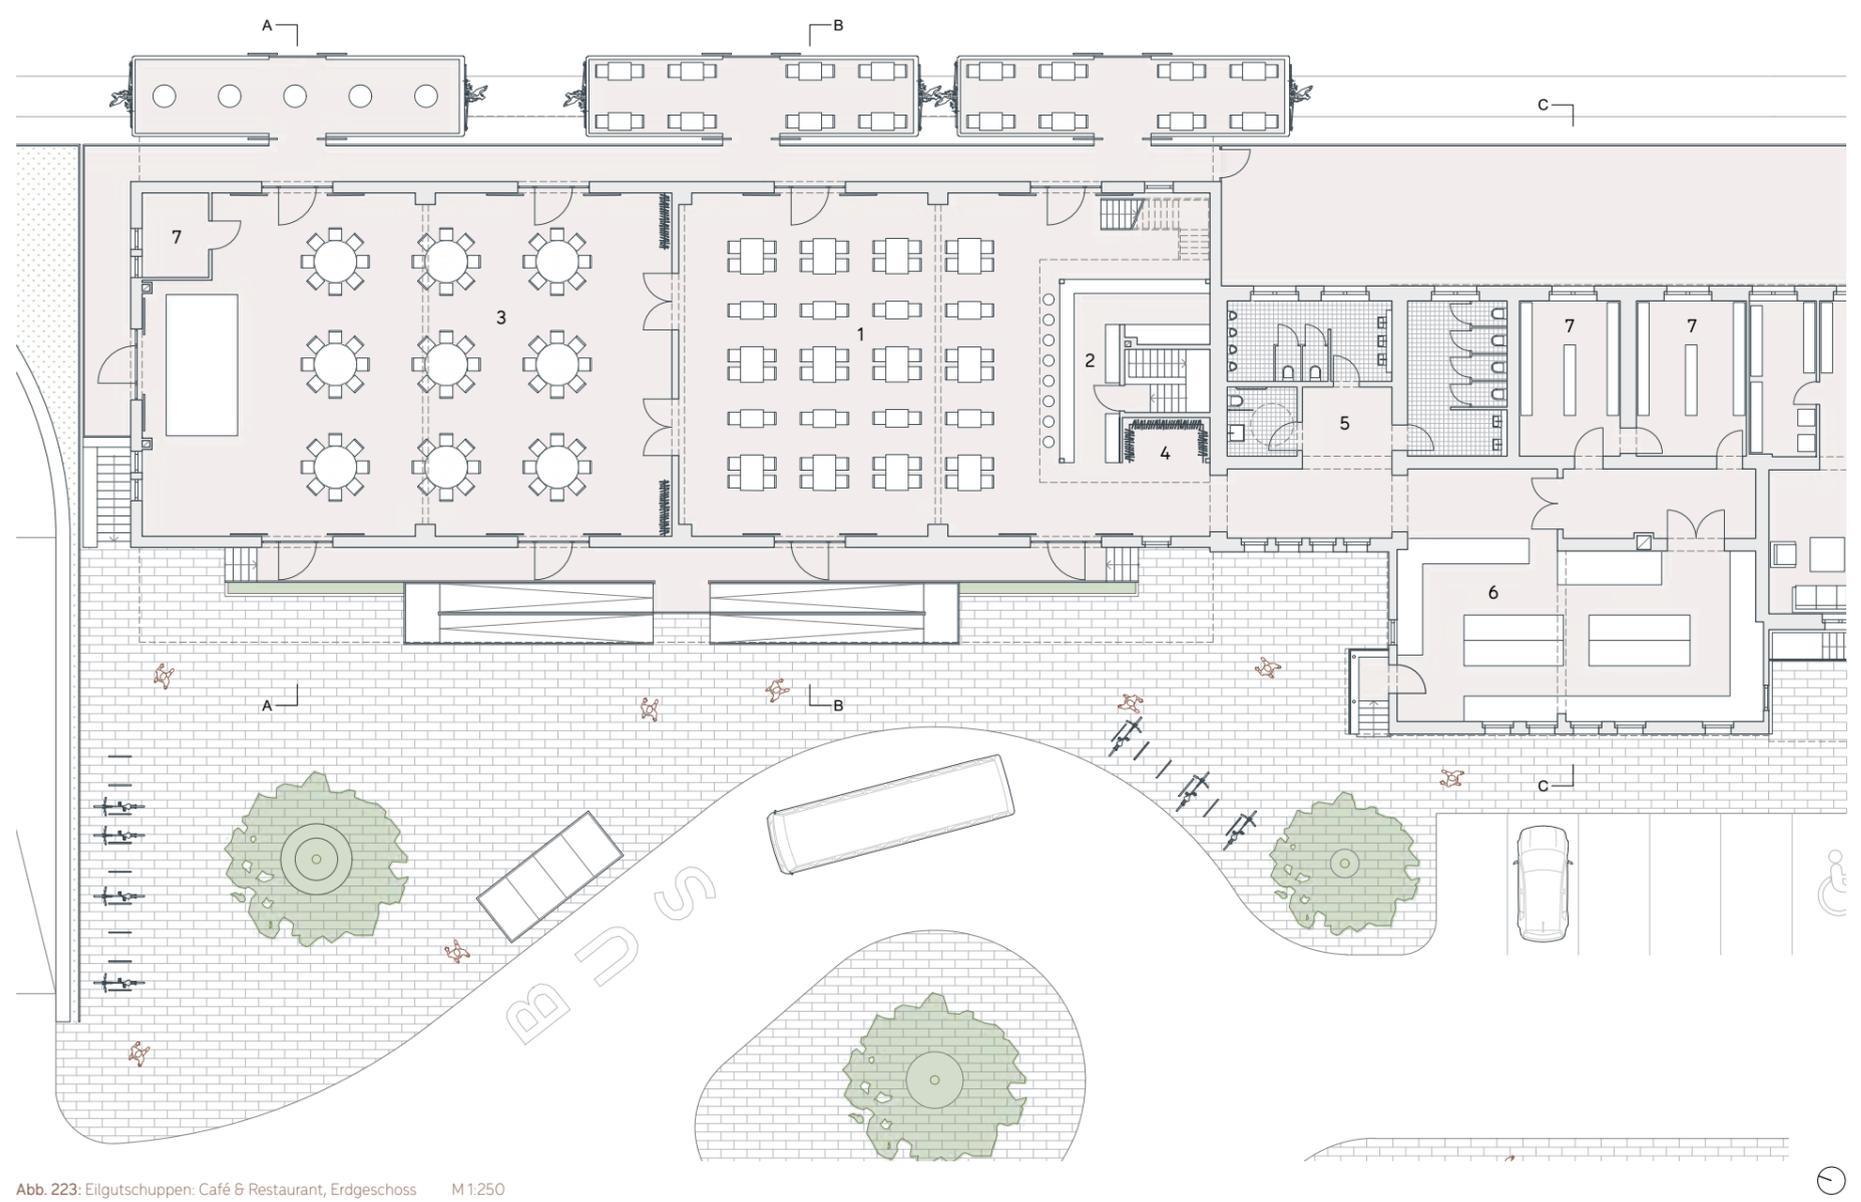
Eilgutschuppen: Café & Restaurant, Erdgeschoss M 1:250
